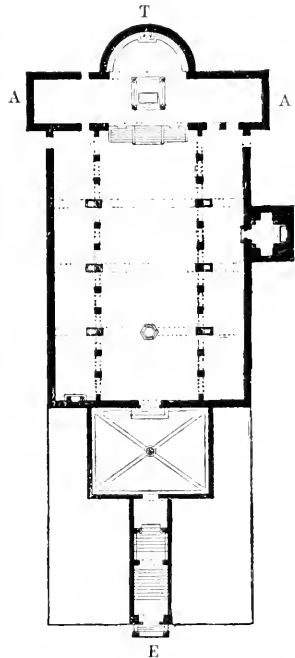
Grundriss von S. Prassede zu Rom.
